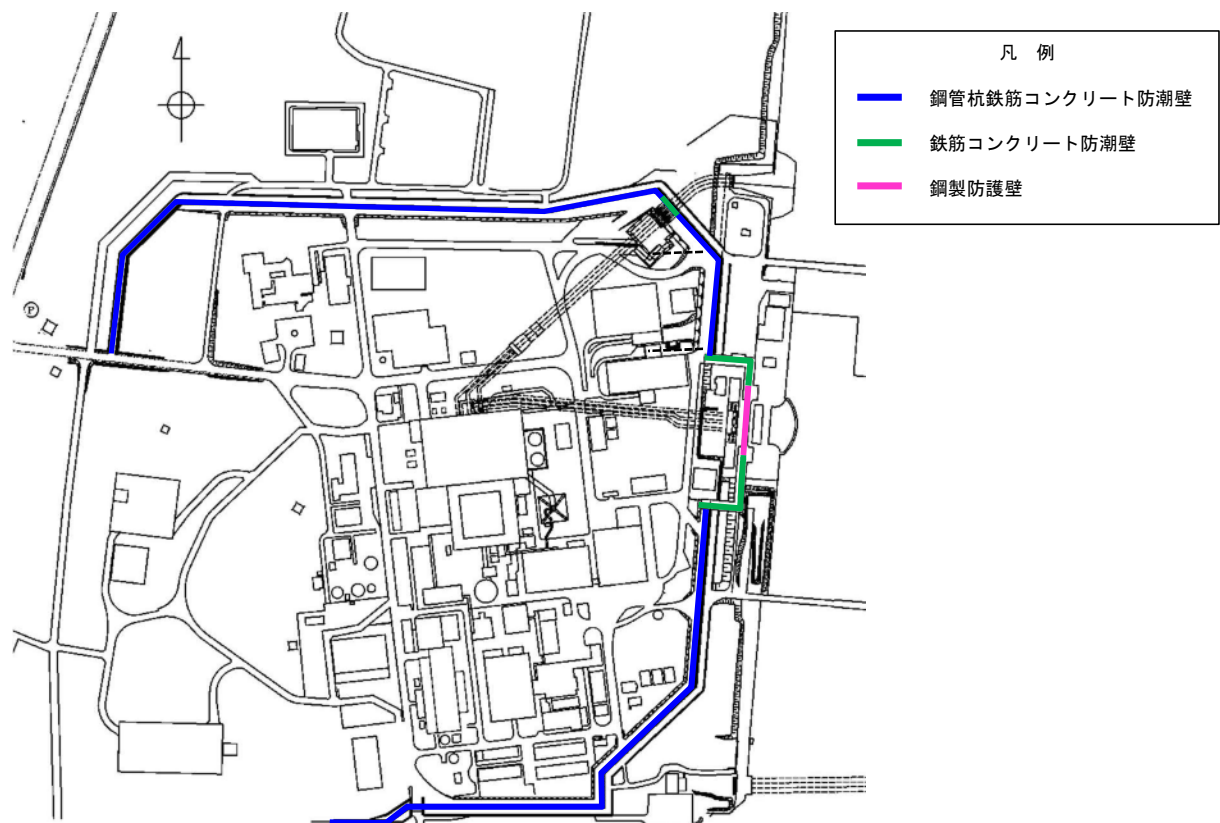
鋼管杭鉄筋コンクリート防潮壁の位置図
